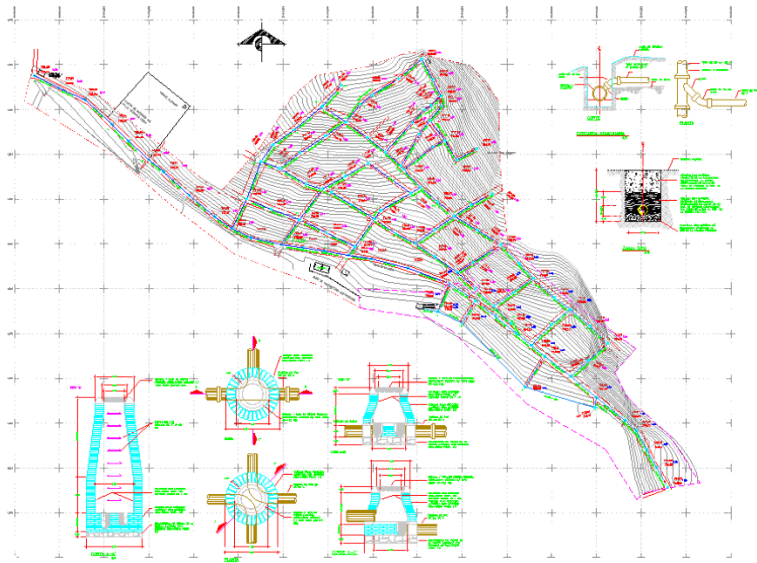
Red de alcantarillado sanitario. Cárcamo 1 y 2. Plano 1/1 (CAPASEG) (Modificada de IMTA 2013).
